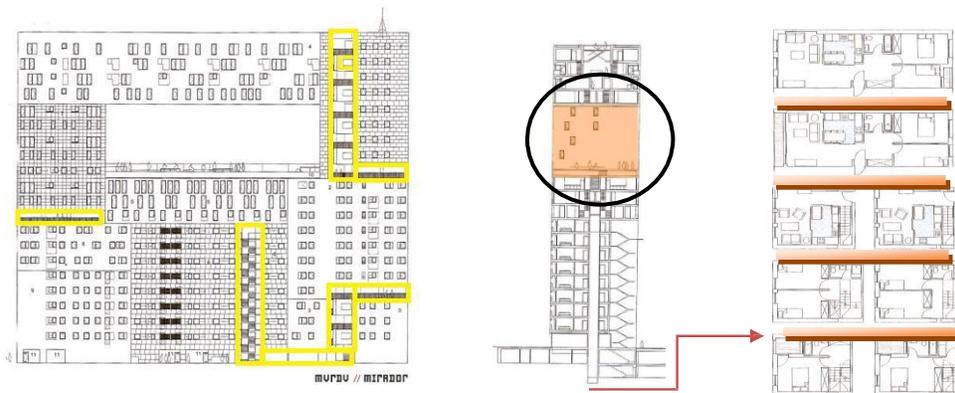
,17,18: Circulación, espacio público, circulación planta tipo.
